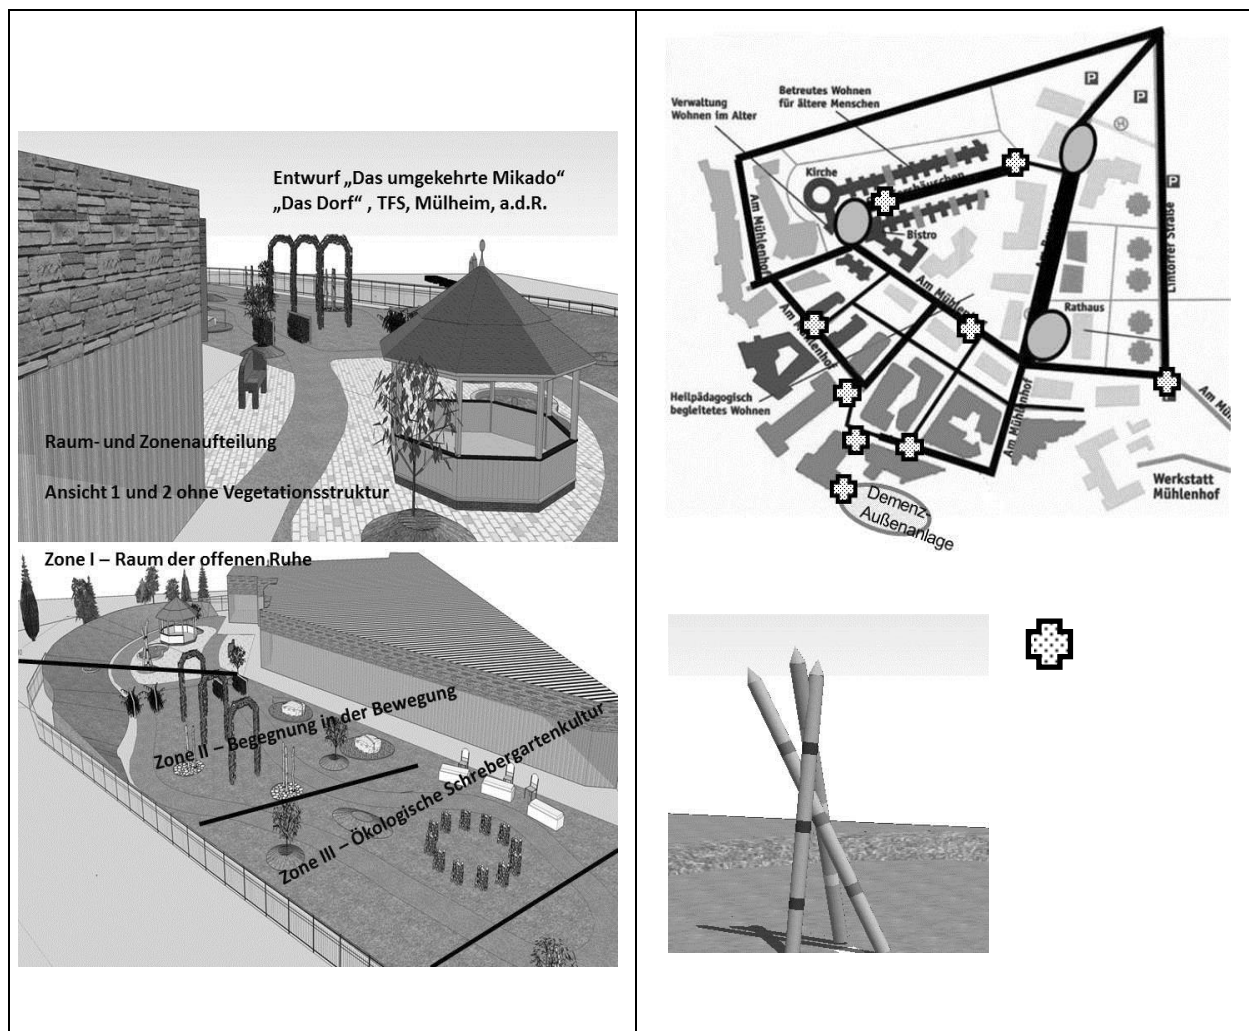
Lageplan der Demenz-Außenanlage im Dorf „Wohnen im Alter“.
